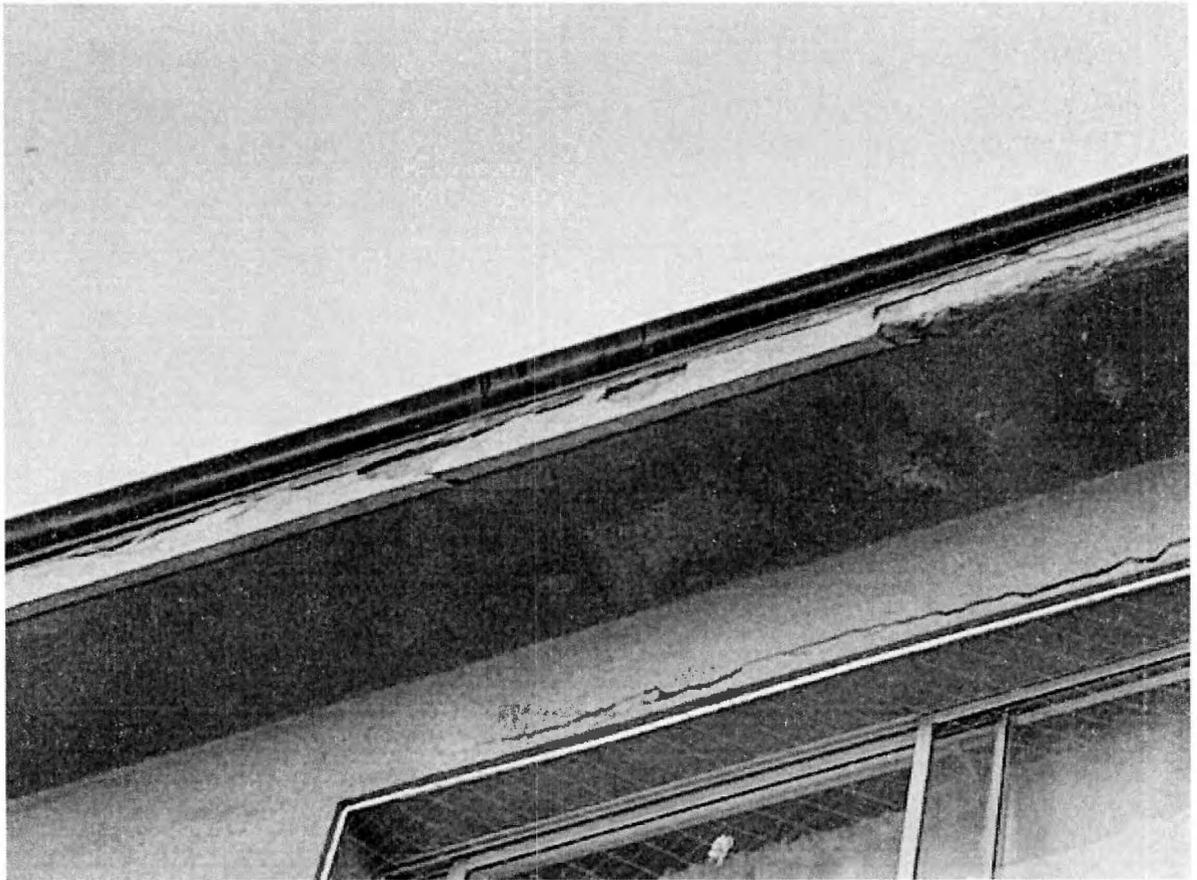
Desprendimiento de recubrimiento en alero de techo y fisura de estuco en ventana de fachada oeste.
